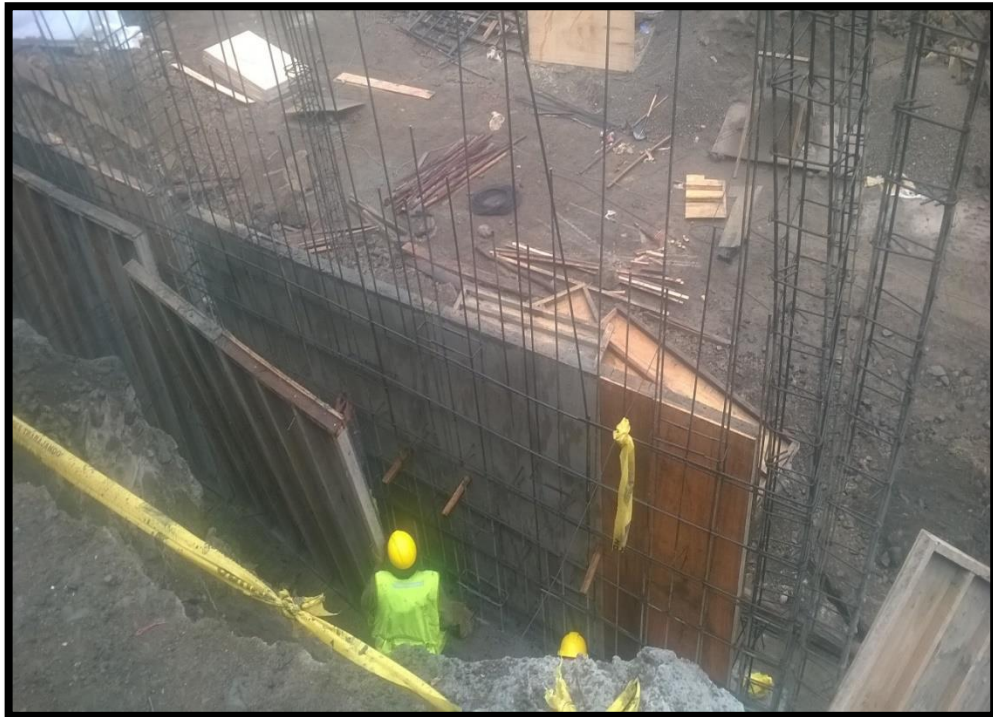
DESENCOFRADO DE LA PANTALLA DEL MURO DE CONTENCIÓN
